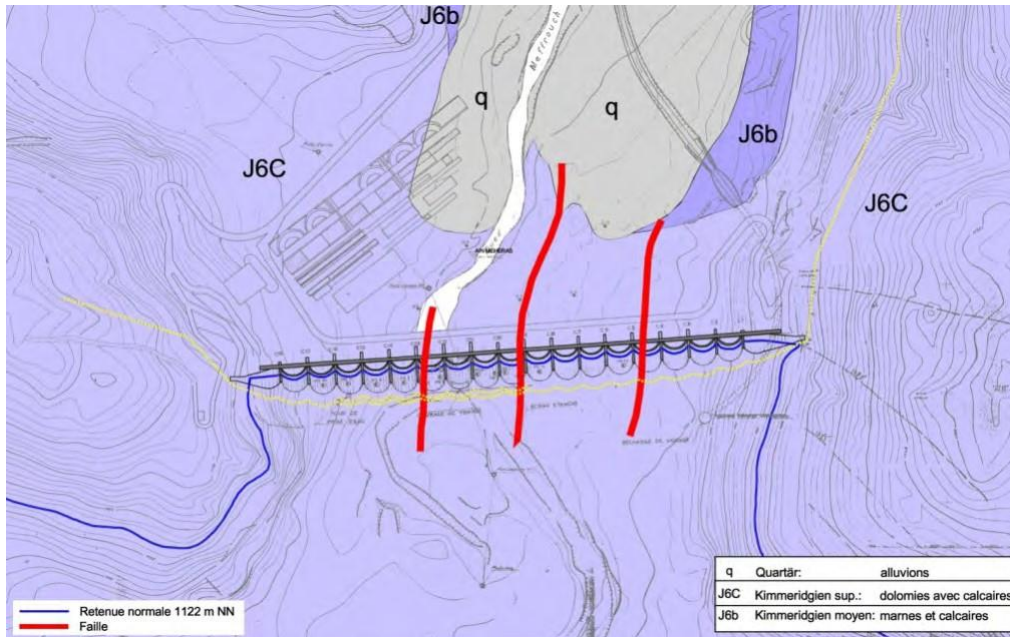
Vue en plan de l'aménagement hydraulique.
